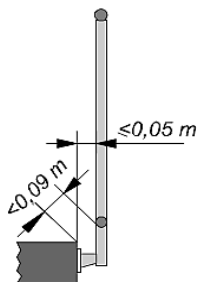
Guarda instalada em plano avançado (IPQ, 2009)
